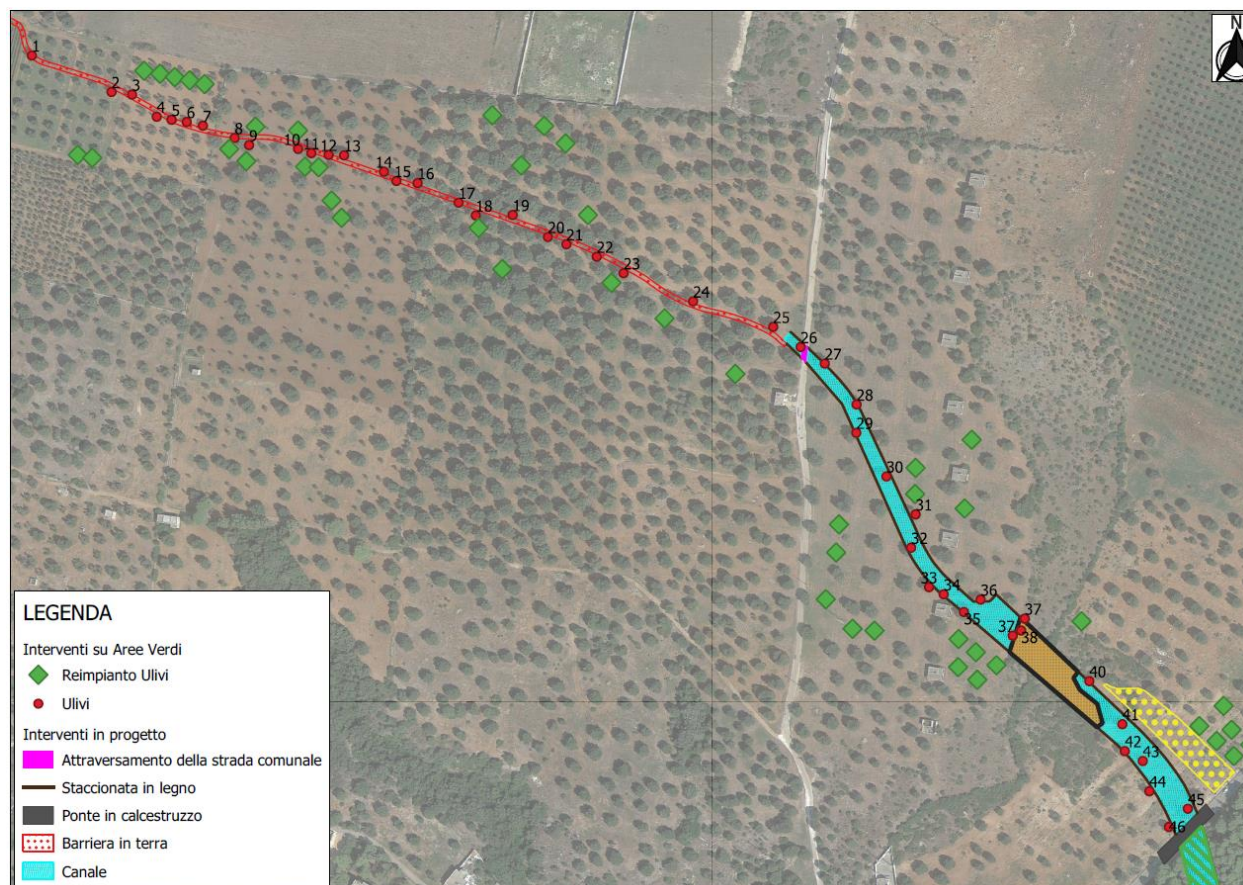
Planimetria con indicazione degli ulivi da rimuovere e ubicazione del reimpianto
